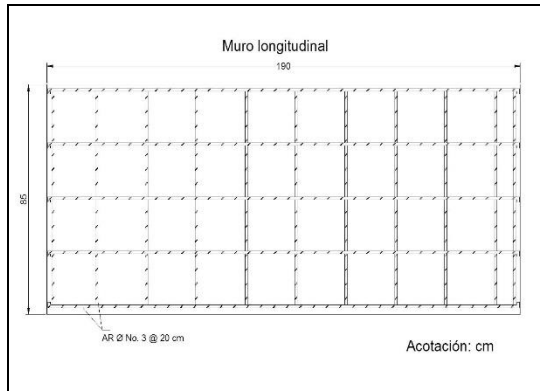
Vista y especificación de muro longitudinal del cajón prefabricado (Armado estructural de acero reforzado).
